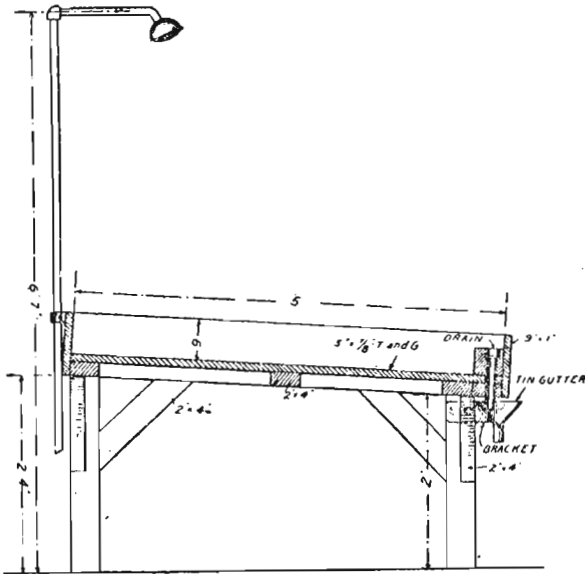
ª — Sección vertical que muestra los detalles de construcción.
